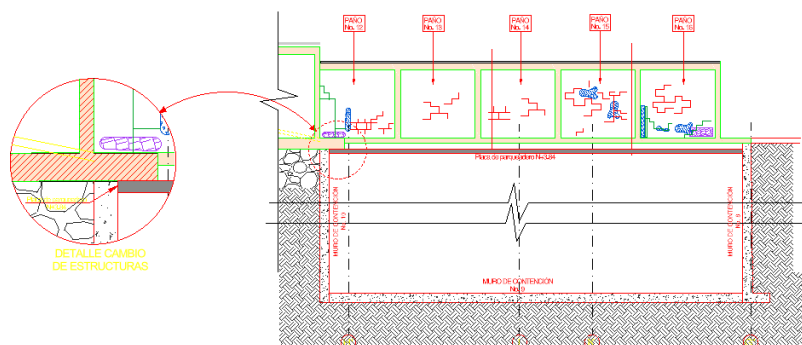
Cambio de tipo de cimentación en el muro de cerramiento.
